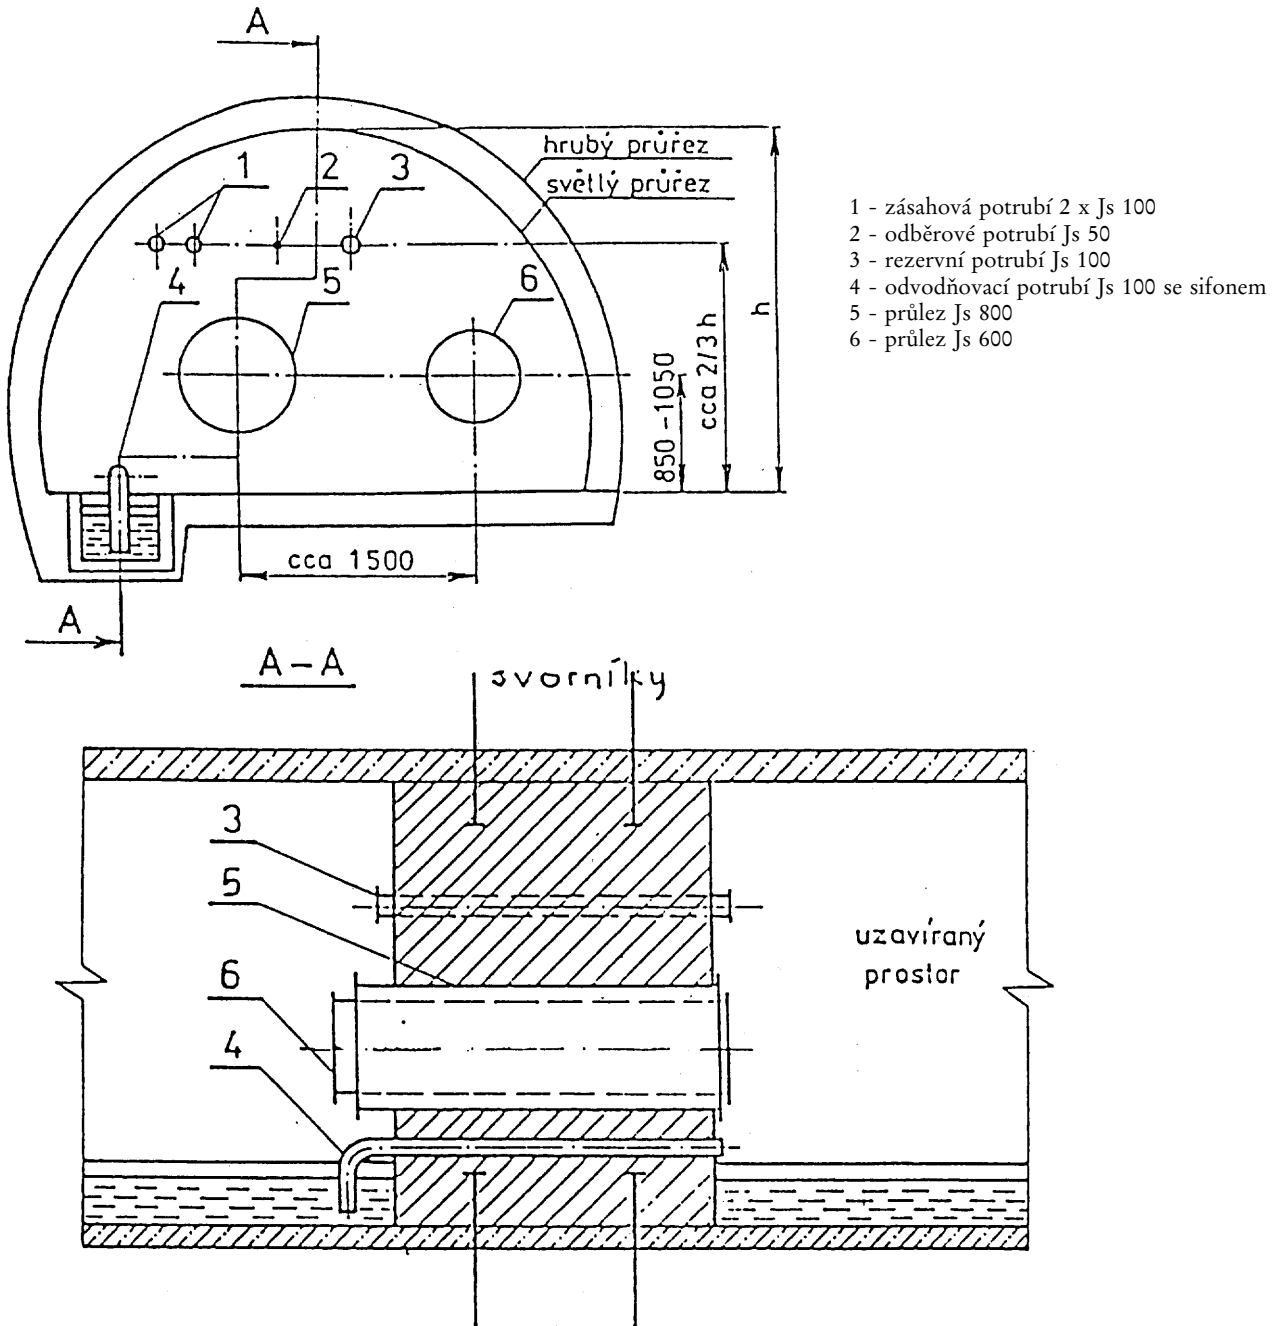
Příklad obezděné hráze s betonovou výplní v důlním díle s betonovou výztuží
